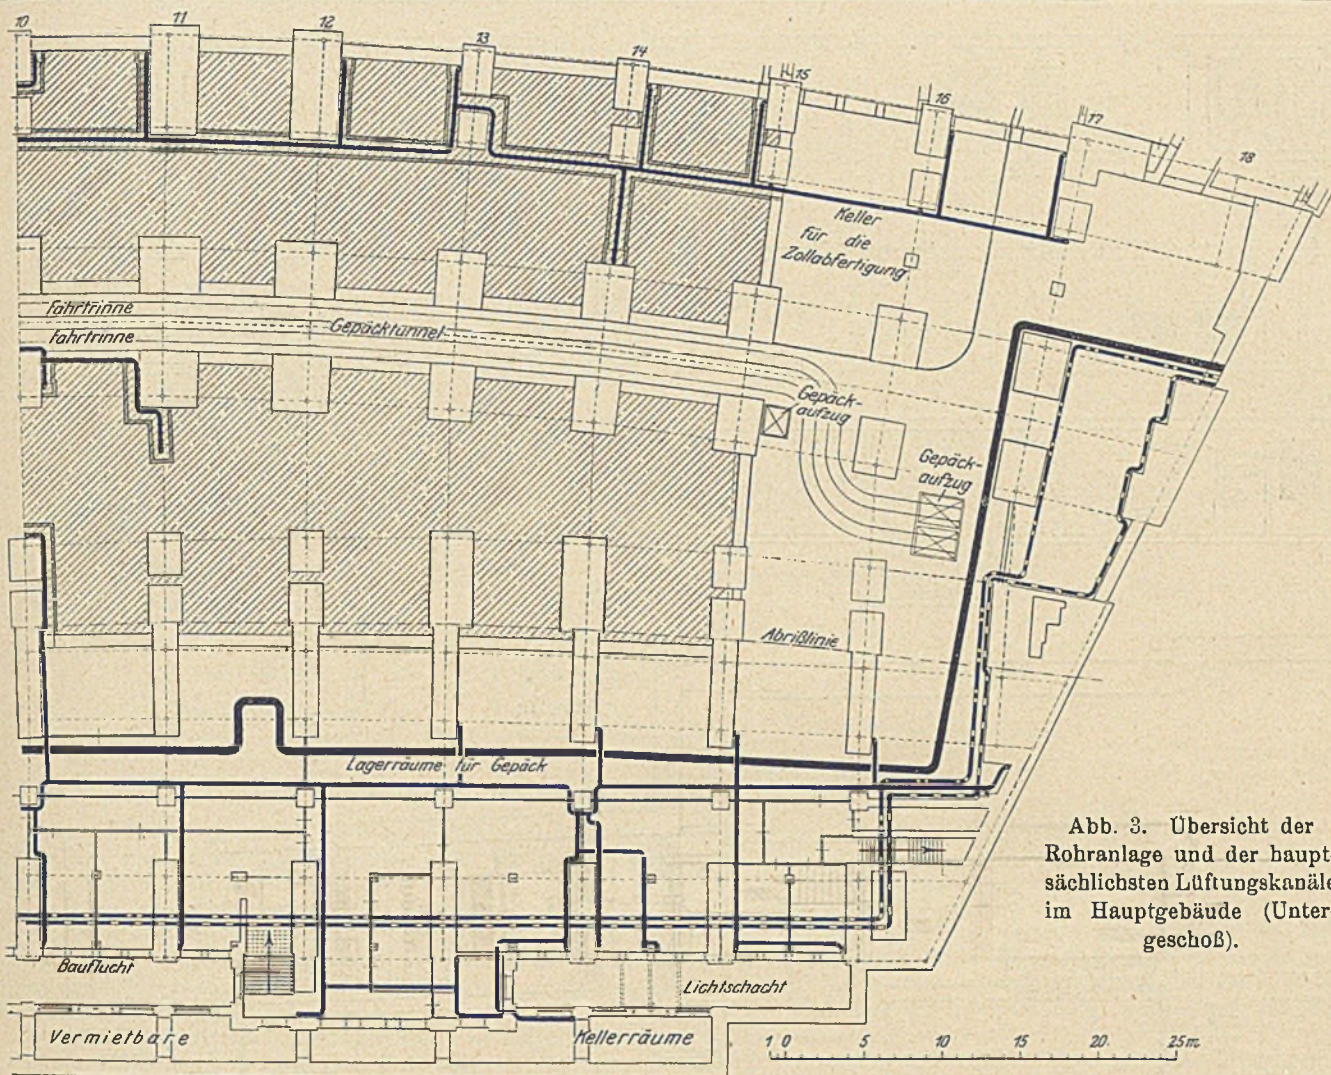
Übersicht der Rohranlage und der hauptsächlichsten Lüftungskanäle im Hauptgebäude (Untergeschoß).
